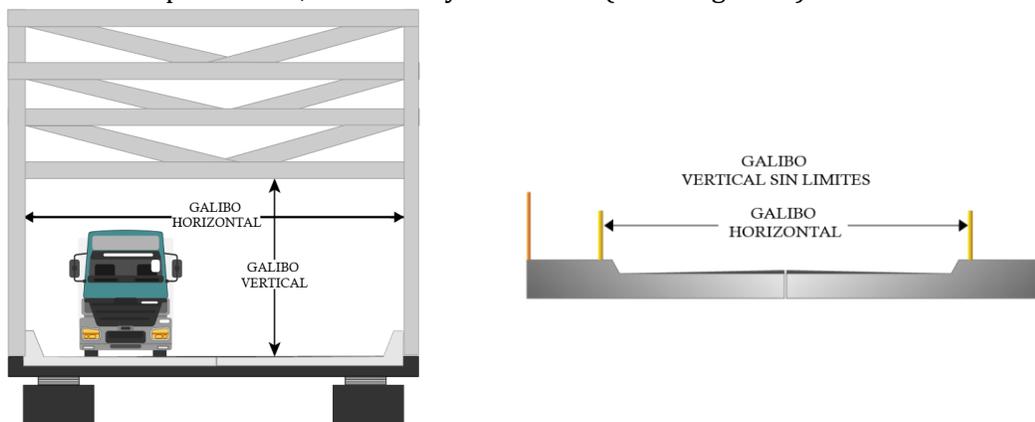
Ejemplos de gálibo horizontal y vertical sobre un puente
